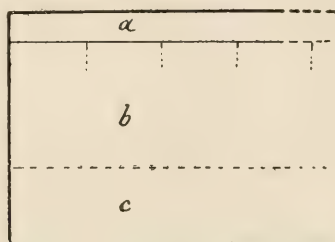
Plan d'une bouverie ou d'une écurie.
